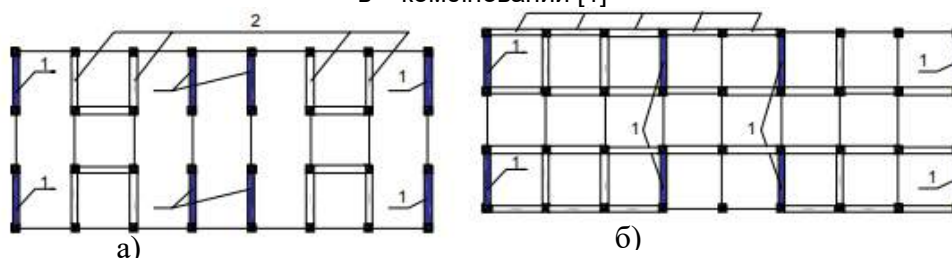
Конструктивні схеми в плані рам і діафрагм каркасних багатоповерхових будівель: а – з поперечними рамами; б – з поздовжніми рамами; 1 – *діафрагми*; 2 – *ригелі* [1]
